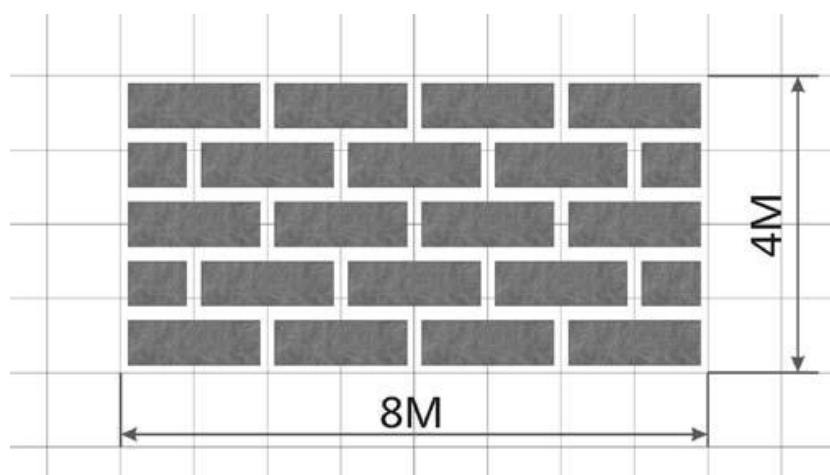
Elevação de parede executada em alvenaria modular de blocos
